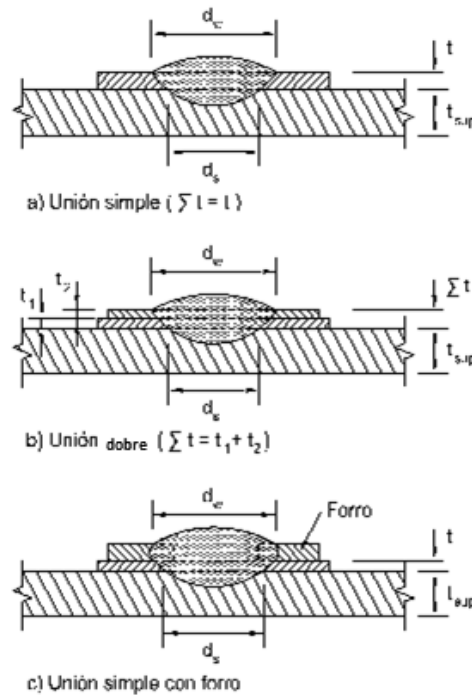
b. Posicións de soldadura de arco por puntos
